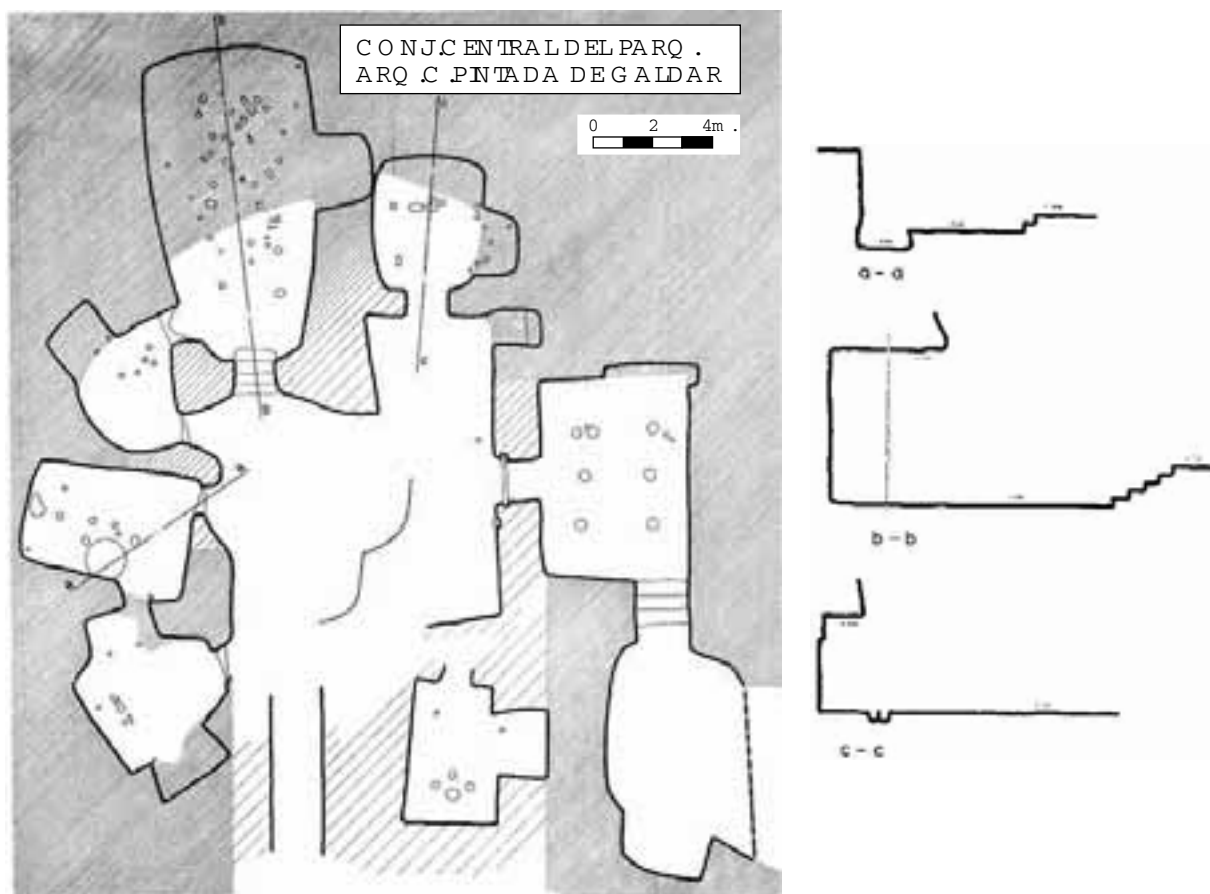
CONJUNTO CENTRAL DEL PARQUE ARQUEOLÓGICO DE LA CUEVA PINTADA DE GALDAR: PLANTA Y SECCIONES. Levantamiento topográfico realizado tras las excavaciones de 1970; a la izquierda la planta del grupo central de cuevas excavadas en la toba, entre las que se encuentra la Cueva Pintada (la unidad mayor y más al norte); se representan con sombreado las zonas intactas. A la derecha tenemos estos perfiles de la C. Pintada y otras dos cuevas. (tomados de Beltrán y Alzola, 1974: 6,7).
